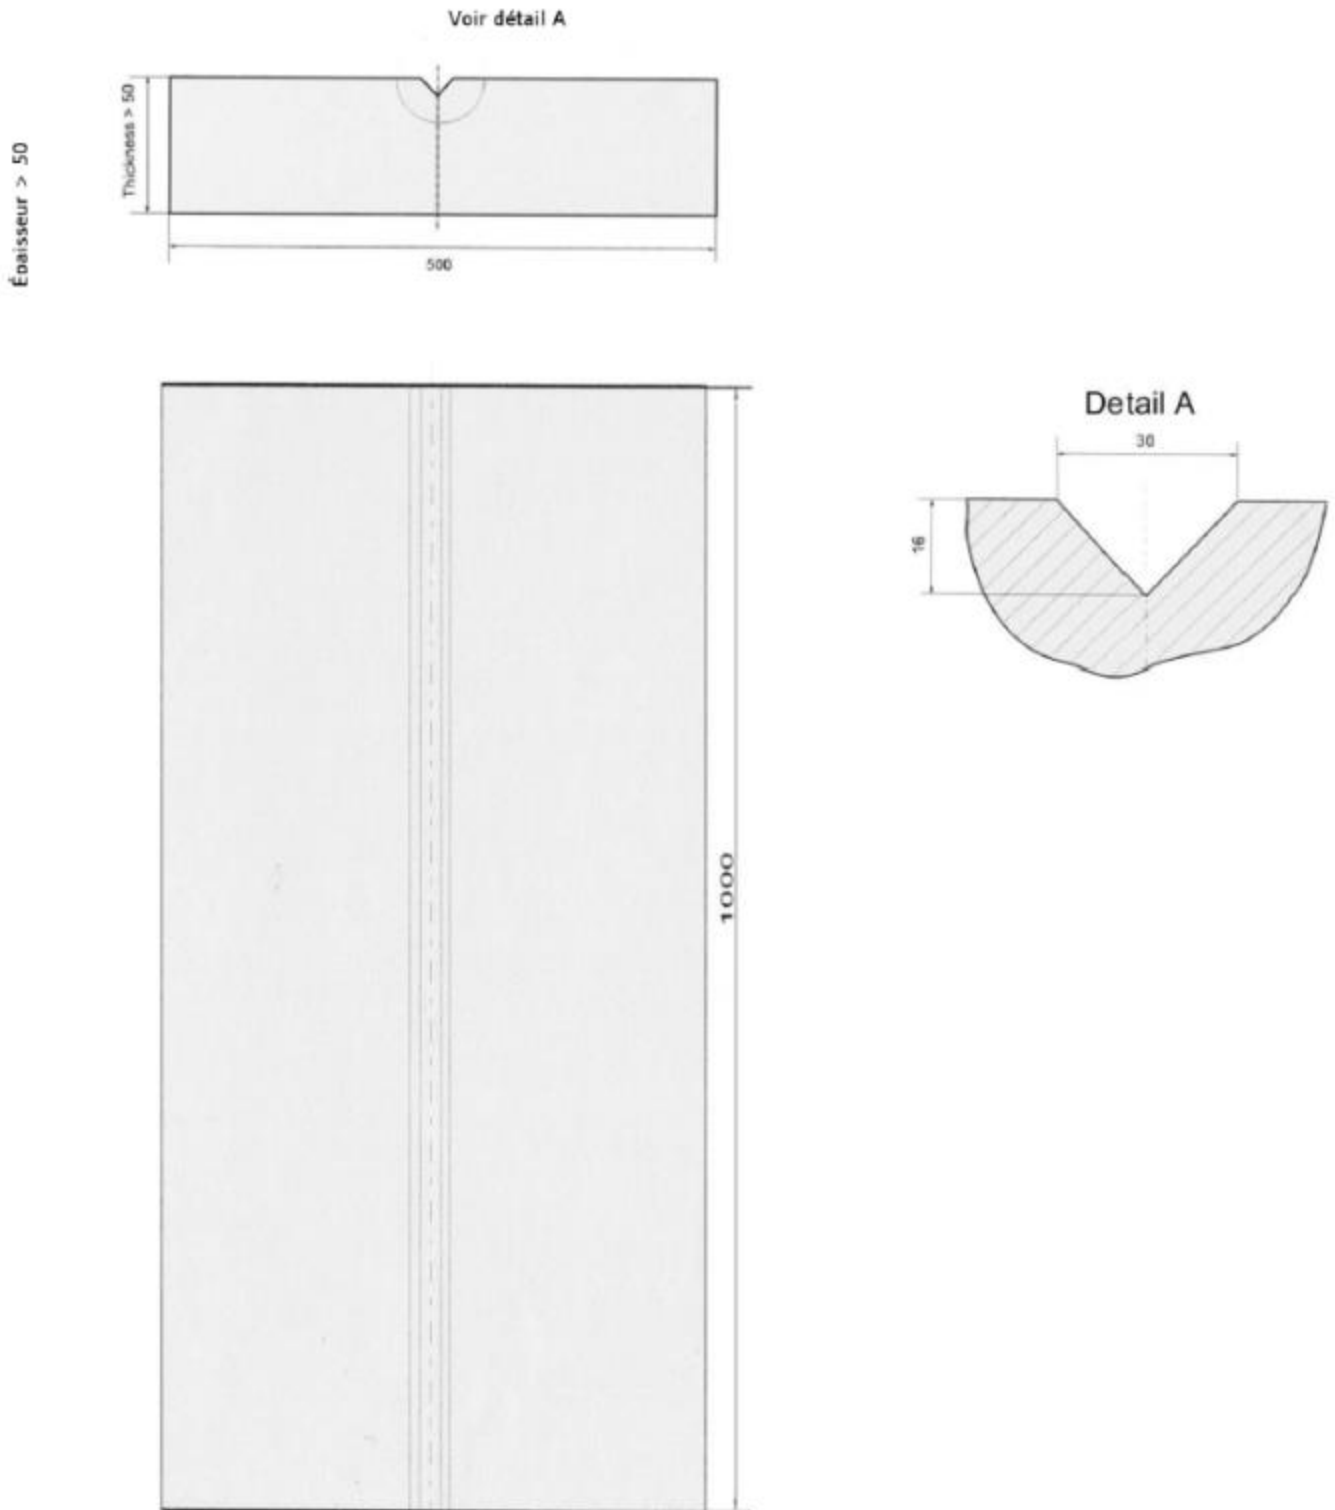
Sto-Panneaux pour Bossage Type III (dimensions en mm)
